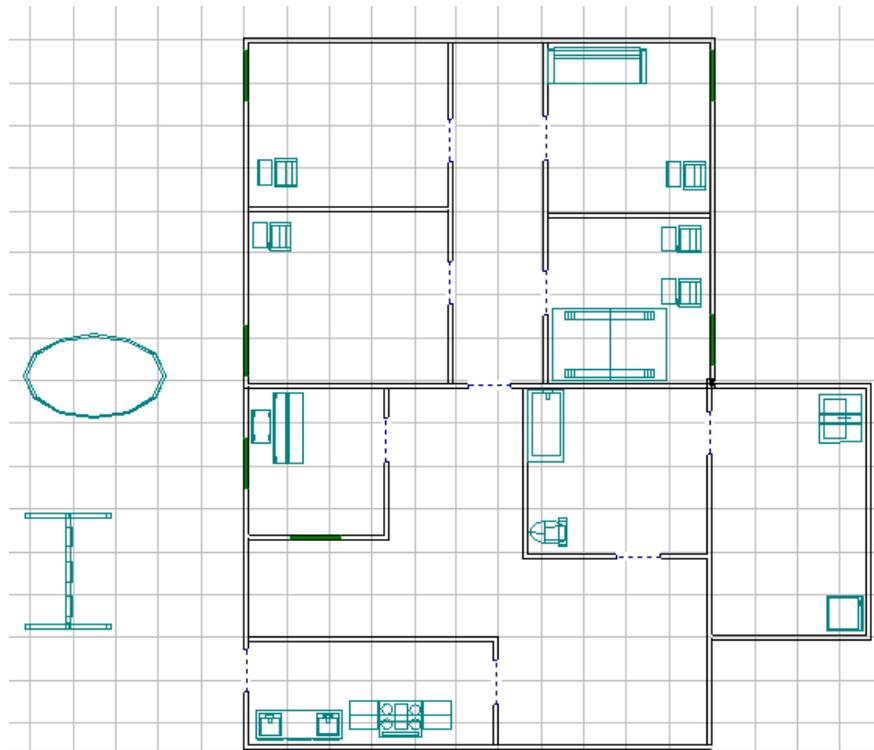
Figura V: Planta baixa de uma casa desenhada no *X-home 3D*.
